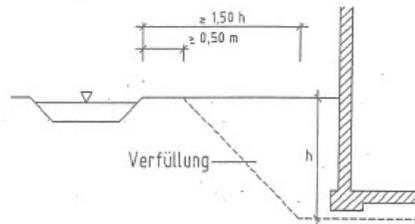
Mindestabstand dezentraler Versickerungsanlagen von Gebäuden ohne wasserdruckhaltende Abdichtung
